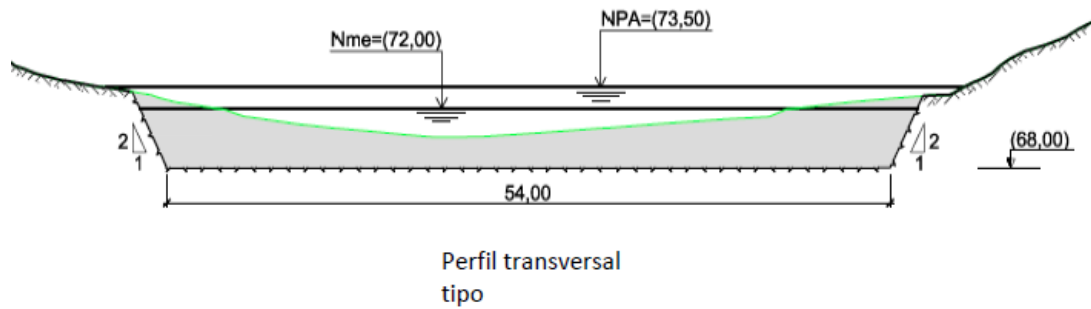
Perfil transversal tipo da escavação do canal de jusante (EDP, 2010)
